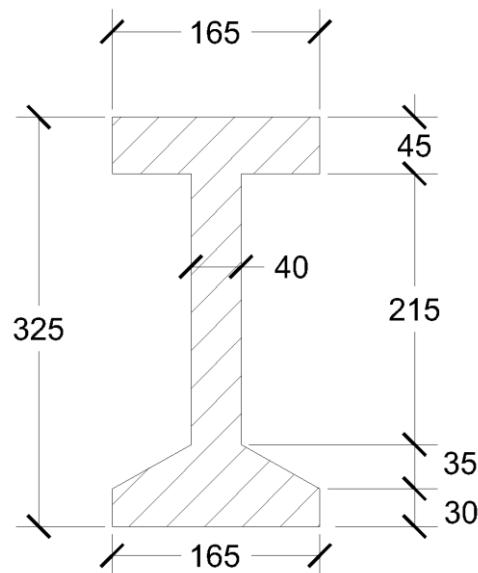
Seção transversal das vigas VP1 e VP2
